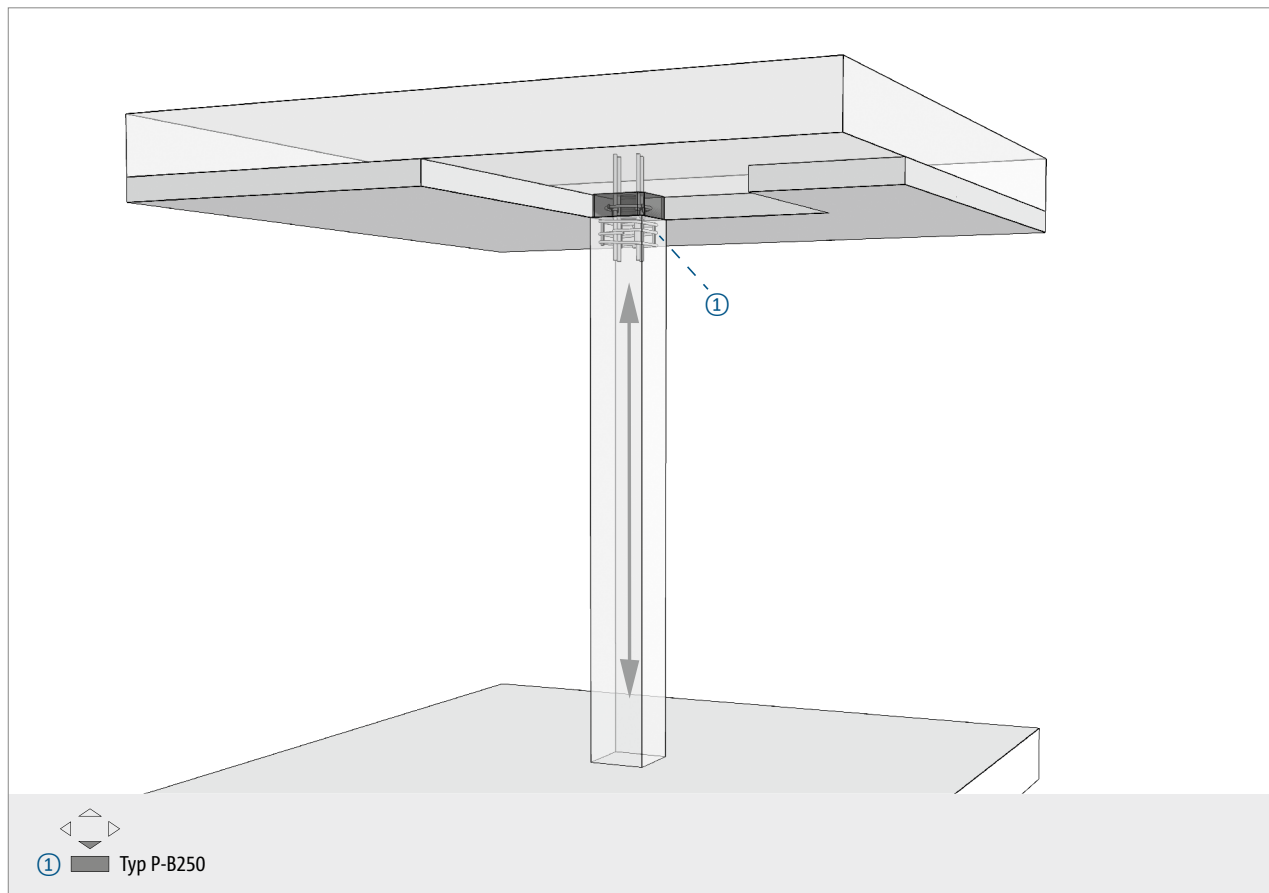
Stützenanschluss bei Unterdeckendämmung
